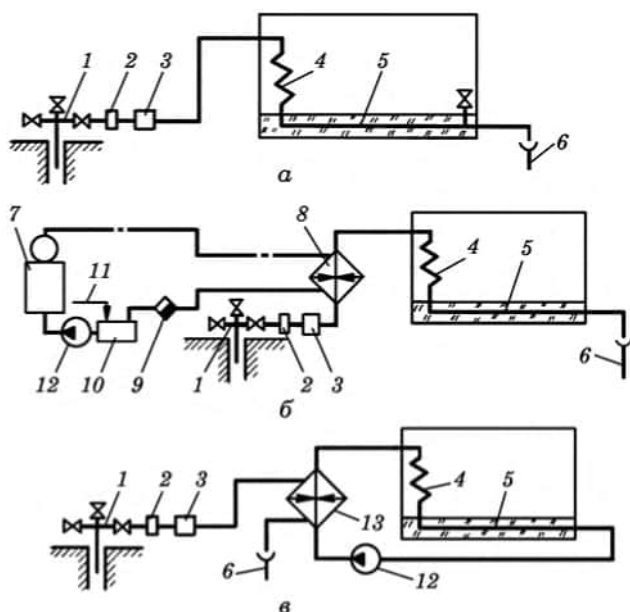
Схемы теплоснабжения теплиц с использованием геотермальных вод:
